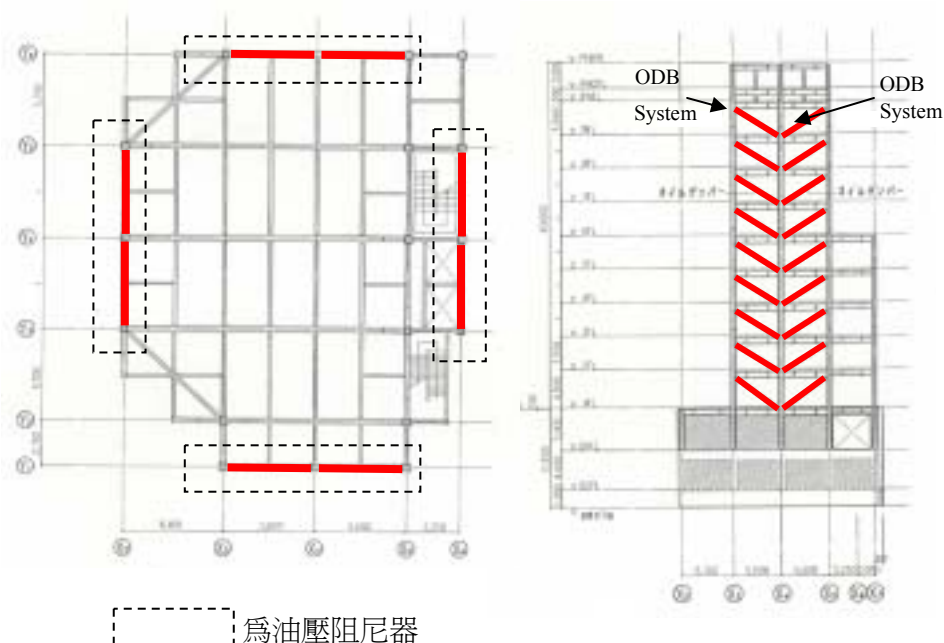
標準樓層平面圖・立面圖及油壓阻尼器配置圖
